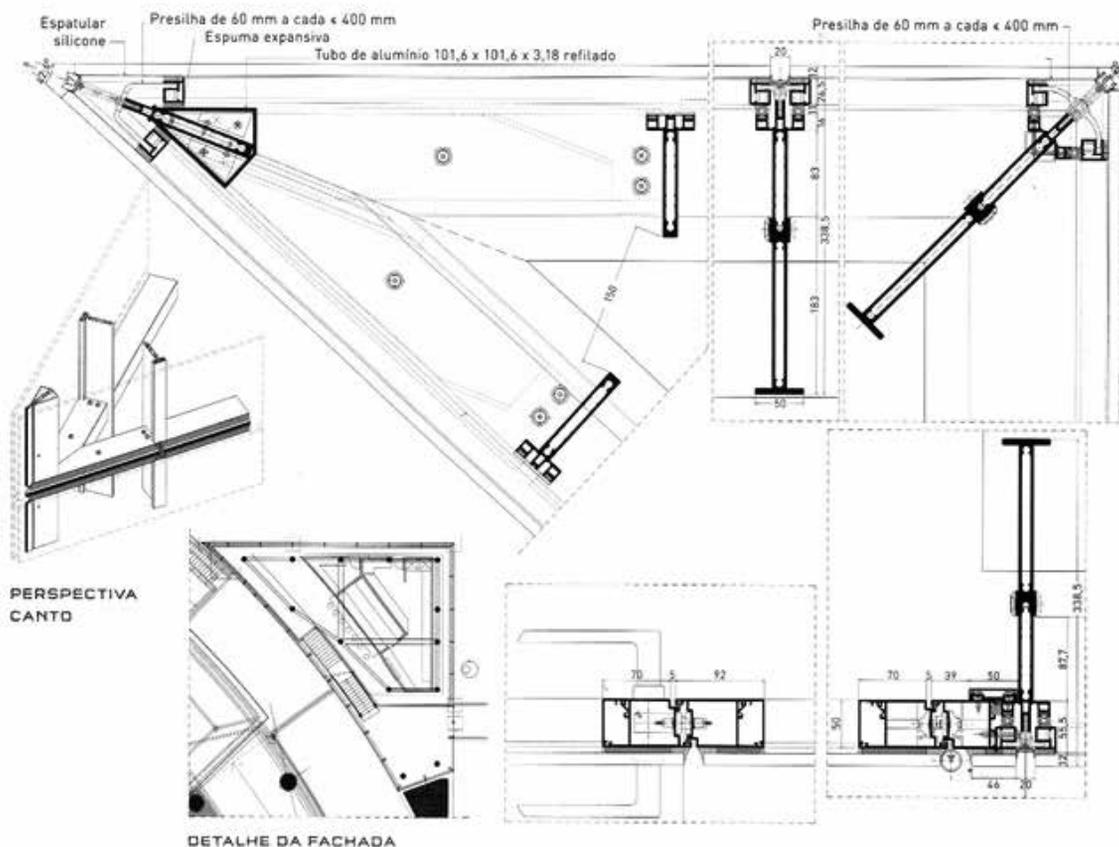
Detalhes do sistema unitizado de fachada – Infinity Tower. (GELINSKI, 2012)
